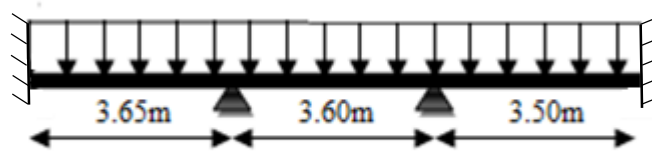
schéma statique de la poutrelle à trois travées
